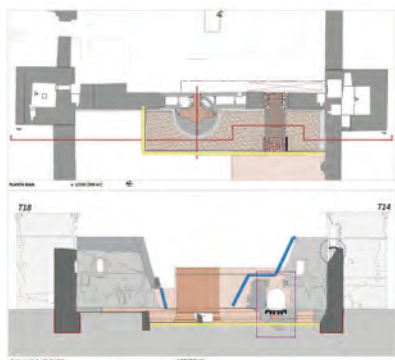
Proyecto de intervención: definición de actuaciones en planta baja y sección – alzado longitudinal
